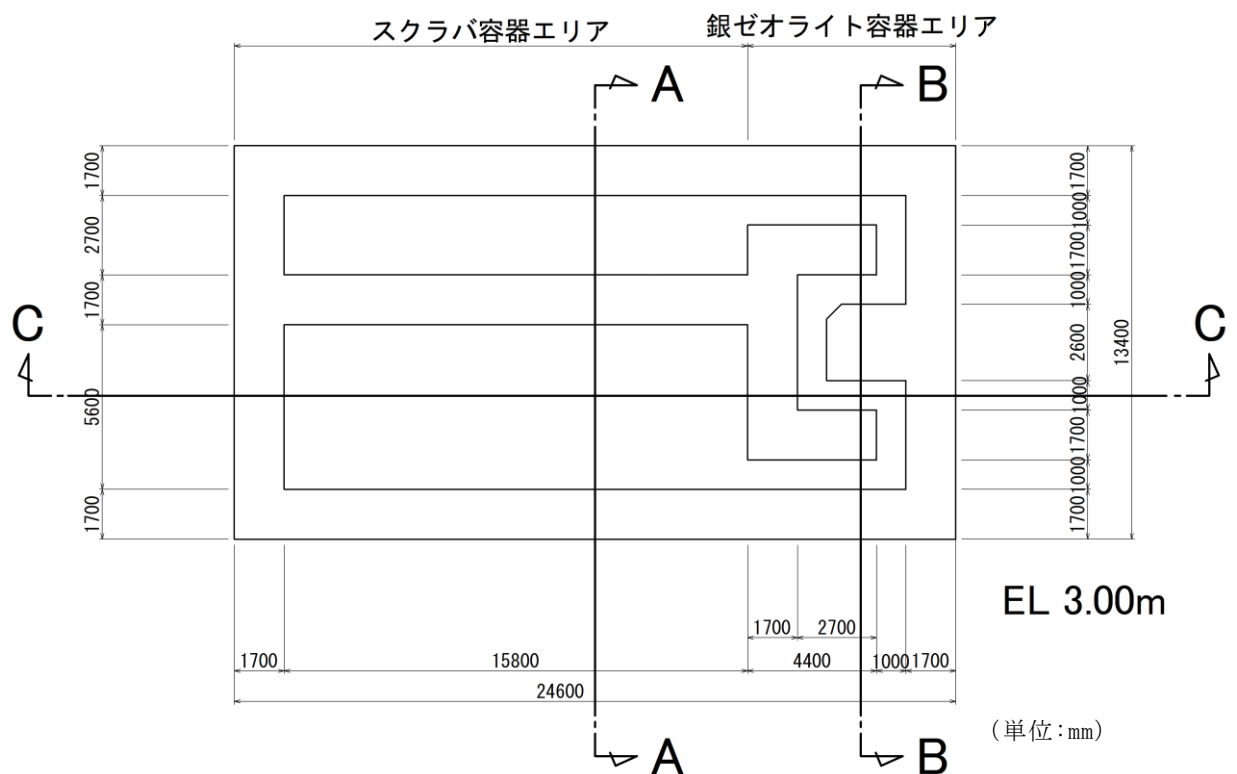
第1ベントフィルタ格納槽 平面図 (EL 3.00m)
